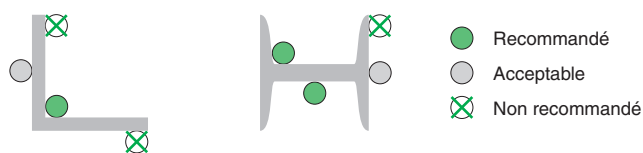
Recommandation pour l'installation de câbles sur poutrelles métalliques
